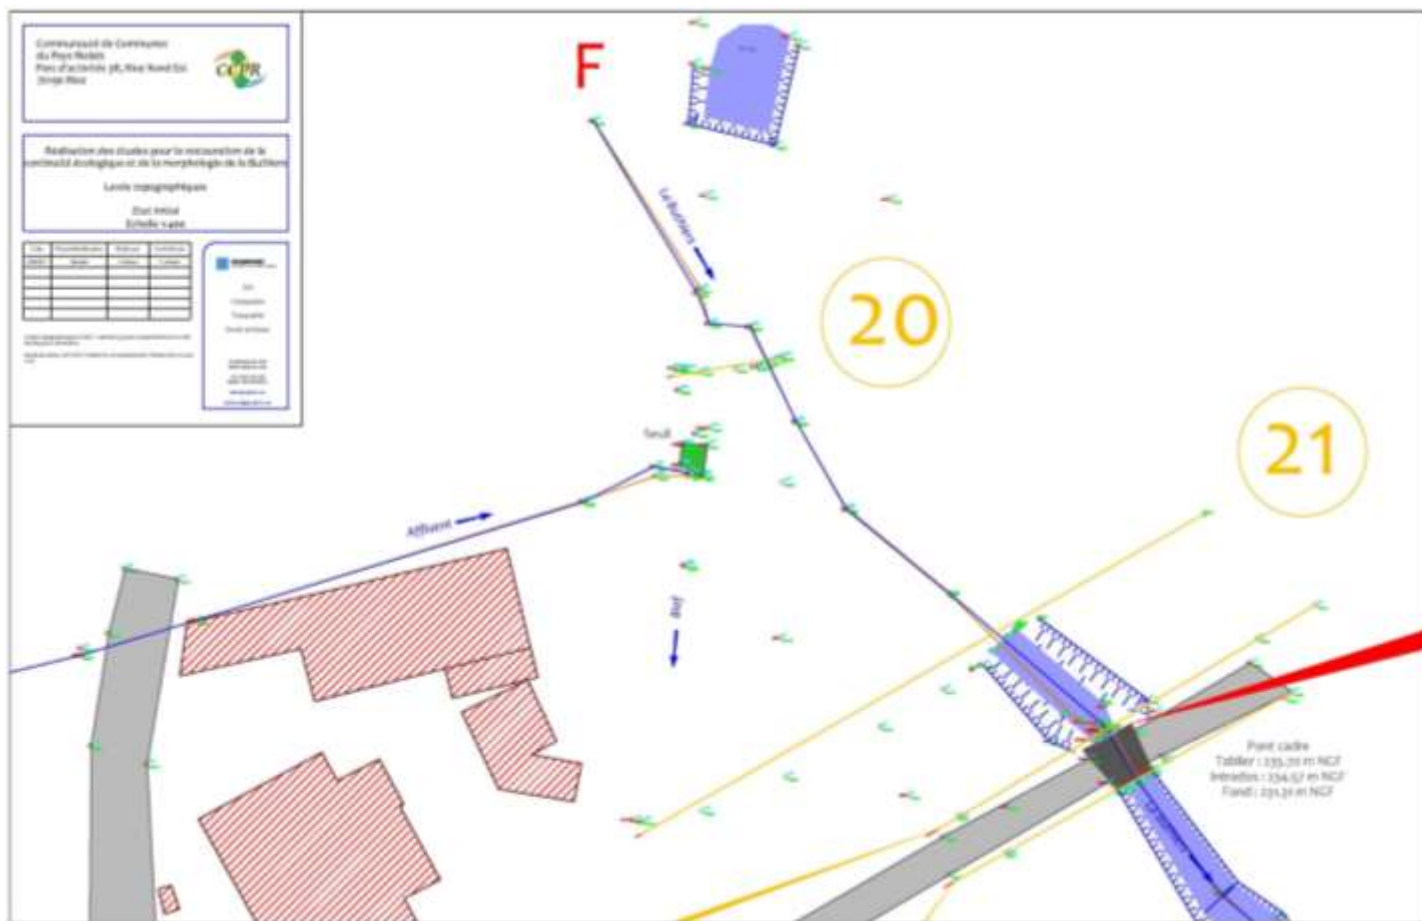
Plan topographique du seuil de Breurey – Zoom sur les ouvrages
